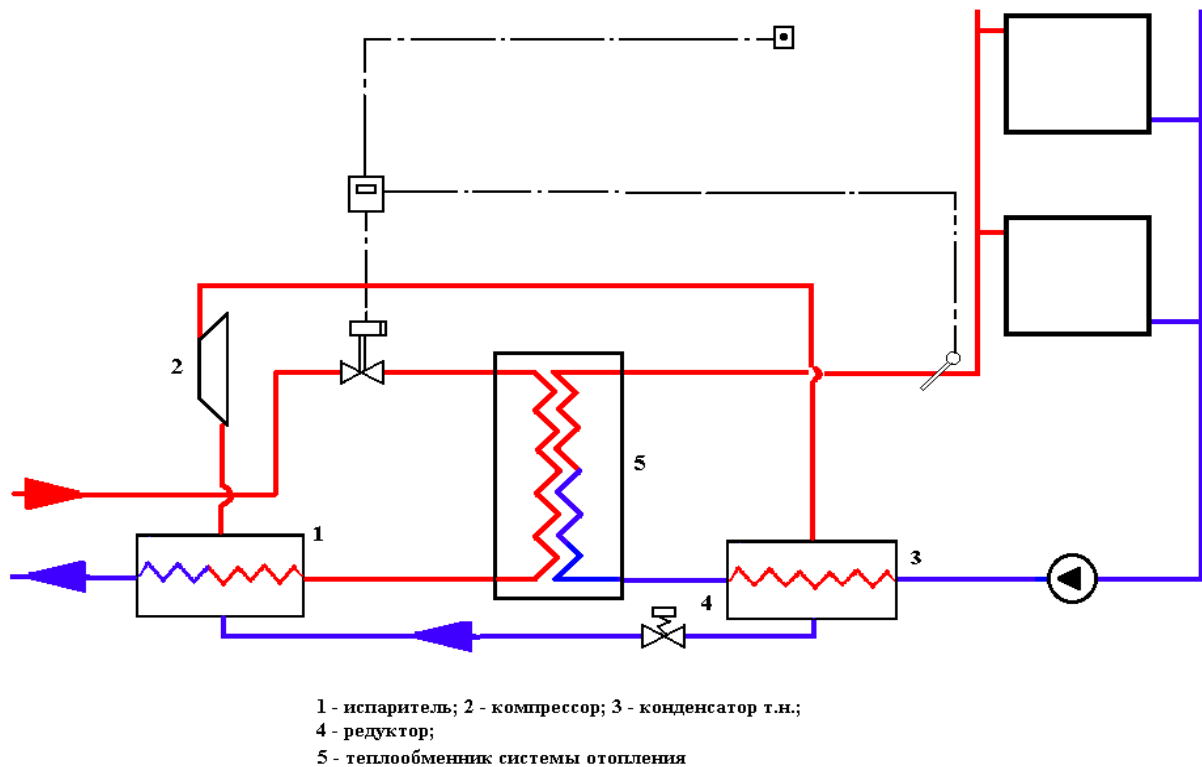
Схема теплового пункта с тепловым насосом с конденсатором на обратном трубопроводе системы отопления
